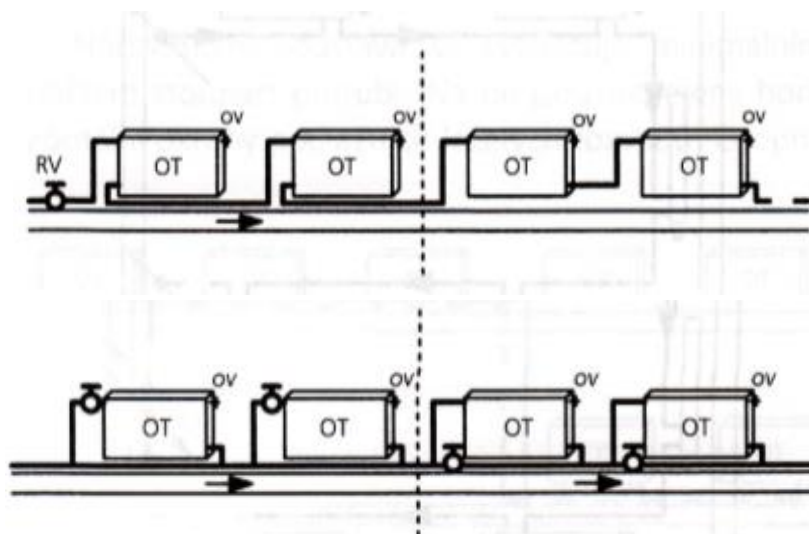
Dvoutrubková a jednotrubková otopná soustava [8]
